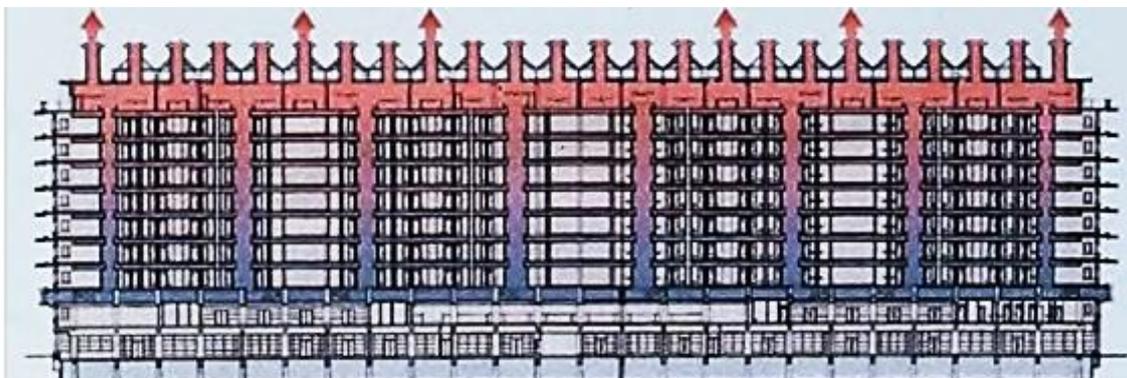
La façade de l'Estgate building (Source : Perce,2007)
